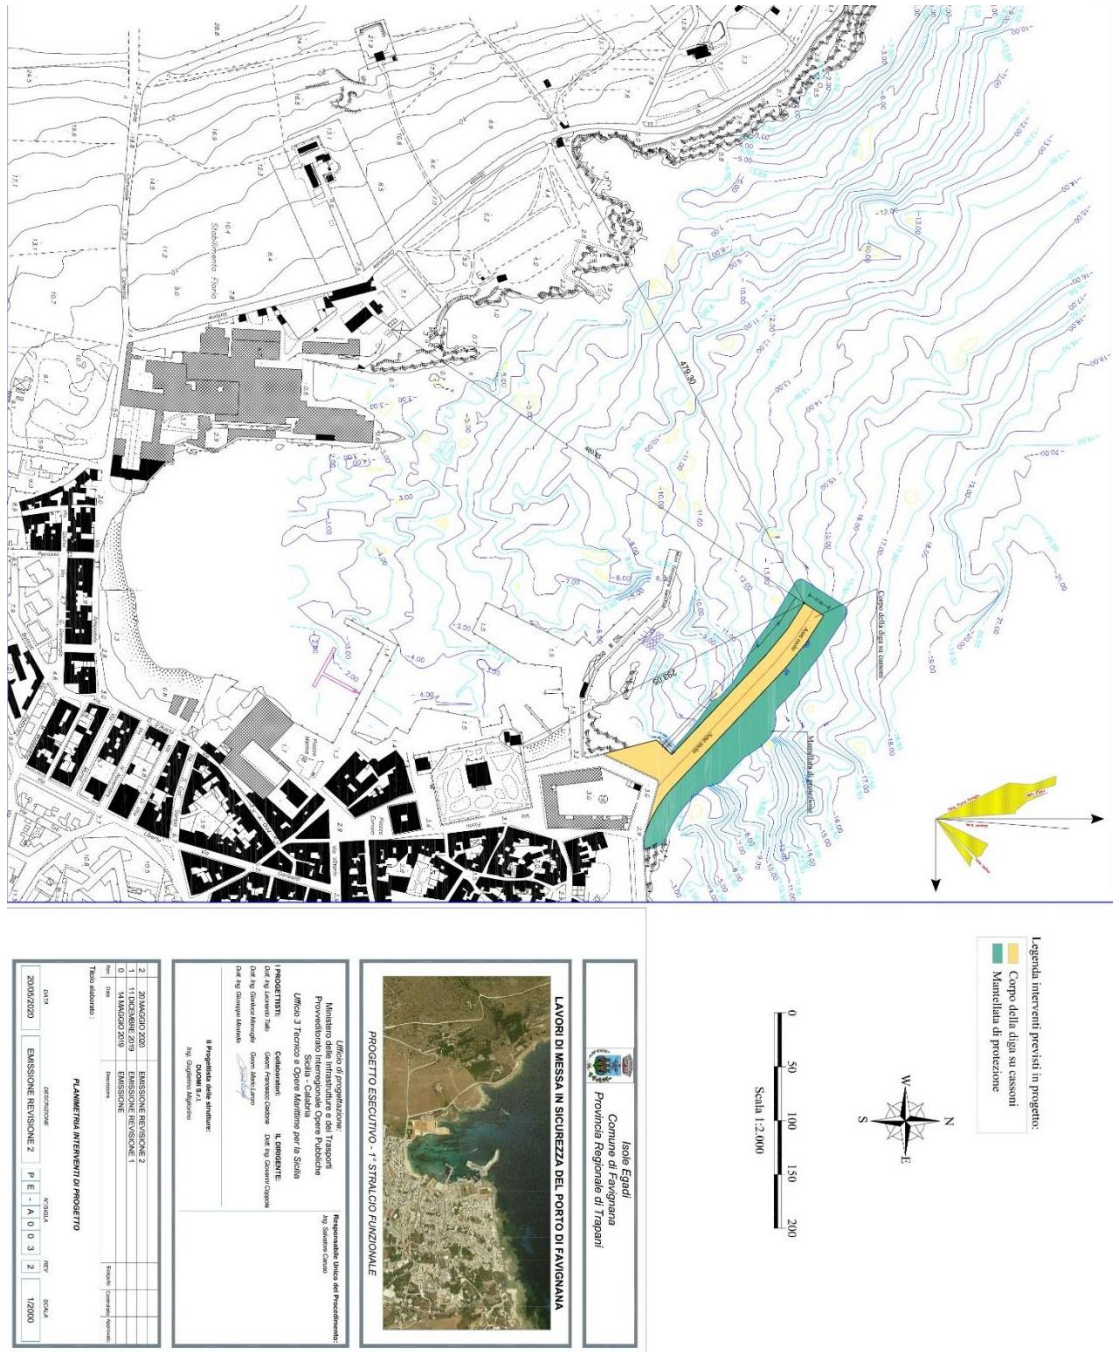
Planimetria del progetto esecutivo (1° stralcio funzionale)
